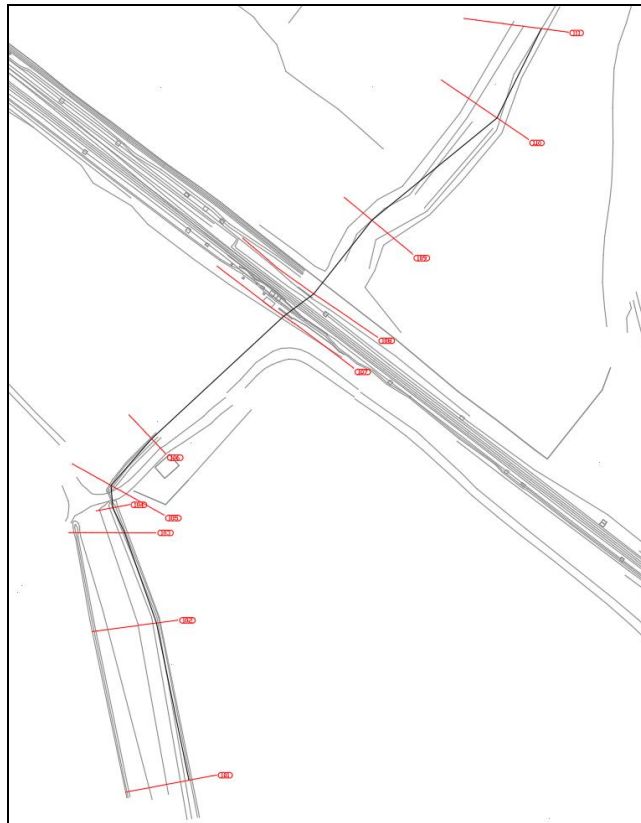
Schema planimetrico dell'asse IN01 e delle sezioni trasversali in condizioni Ante Operam
